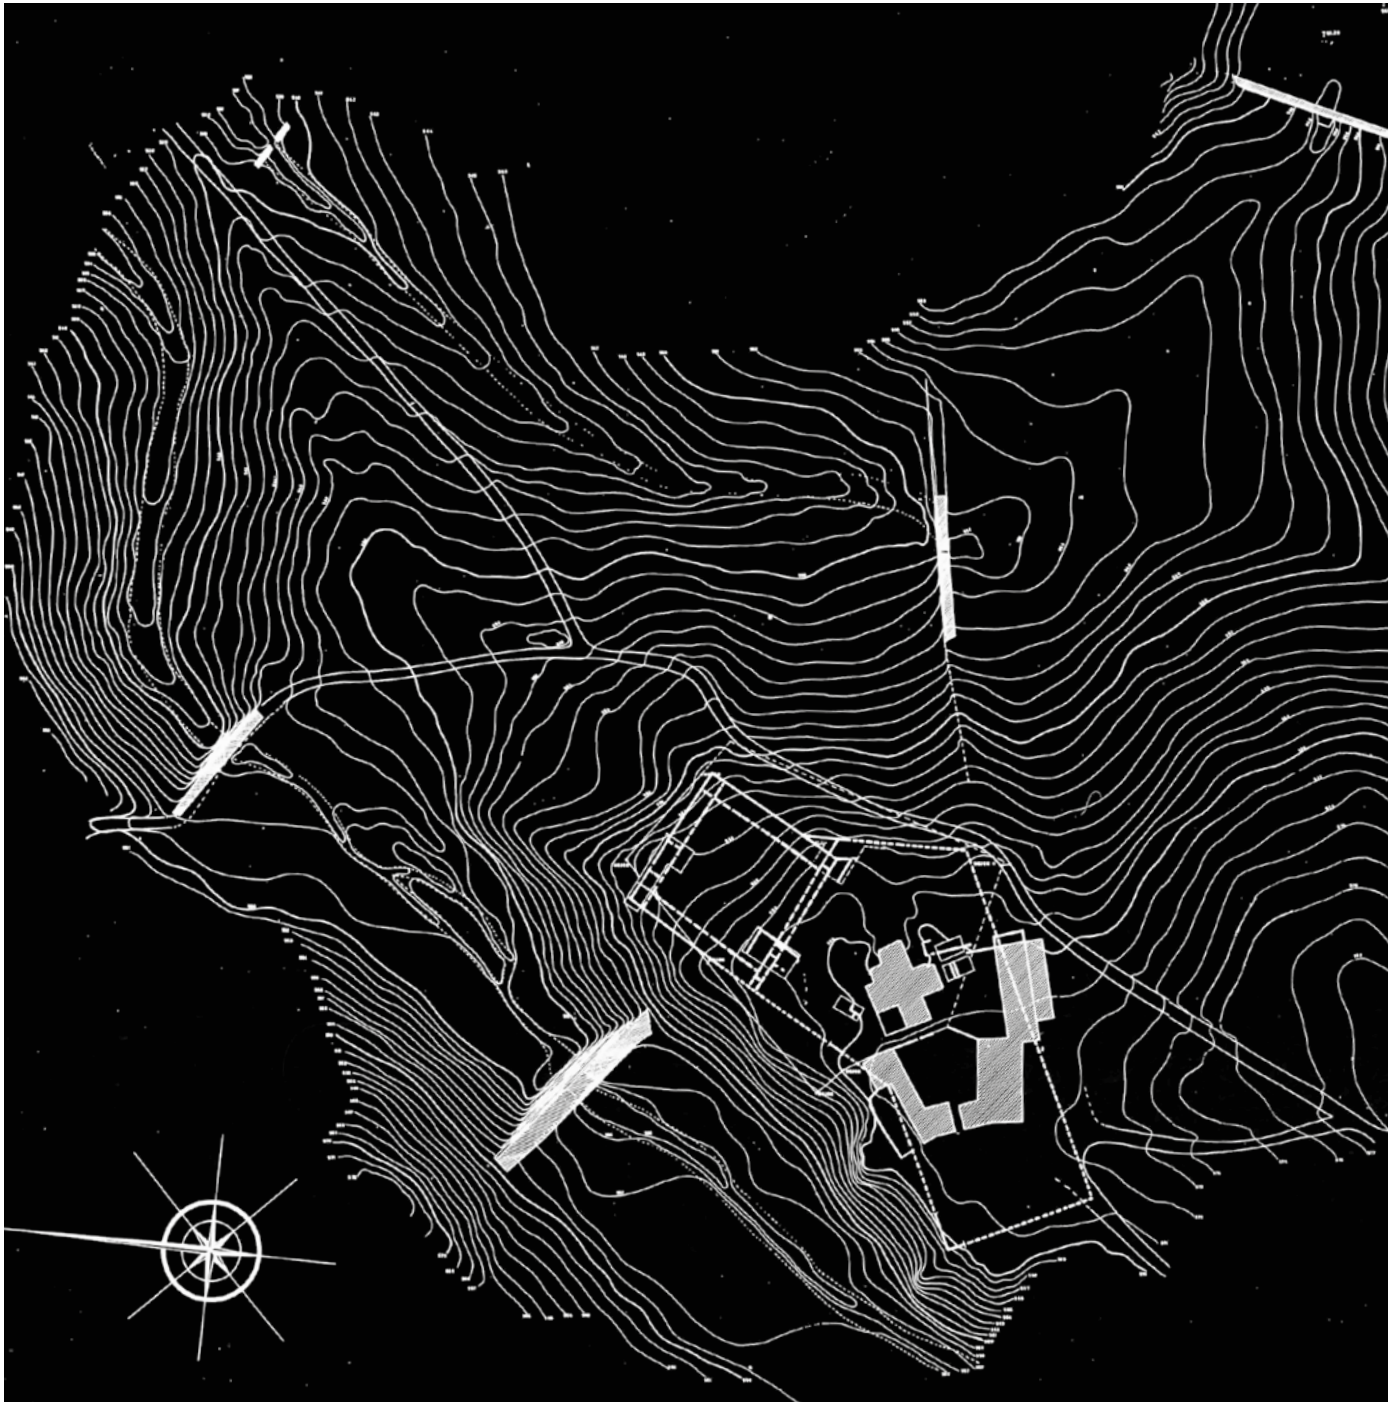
Conjunto arquitectónico de Melque. Fuente: Caballero.
